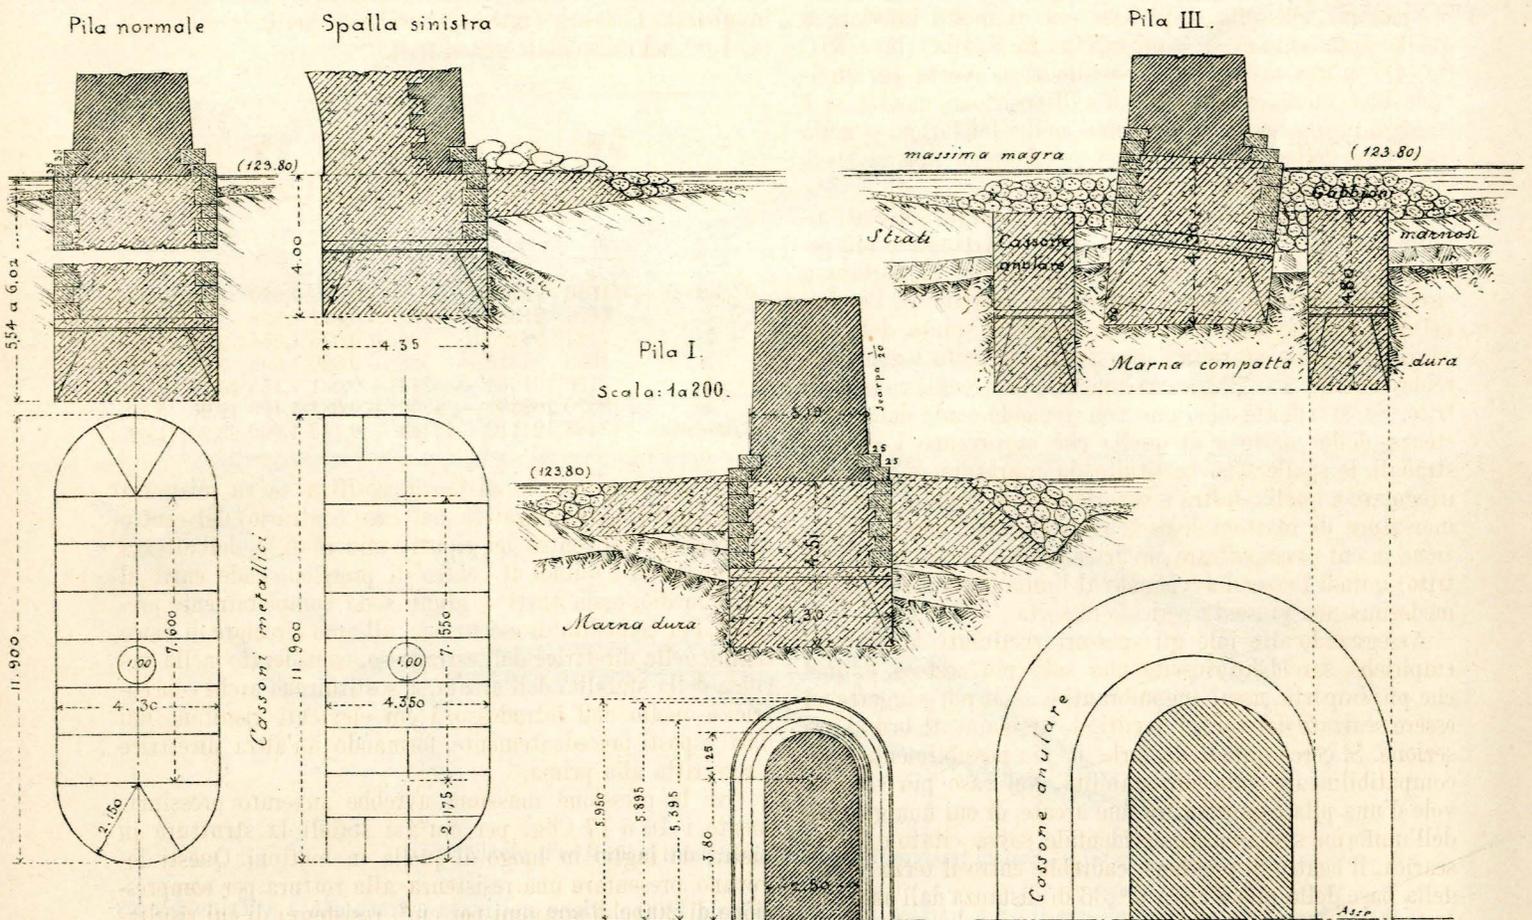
Particolari di fondazione di pile e spalle.
